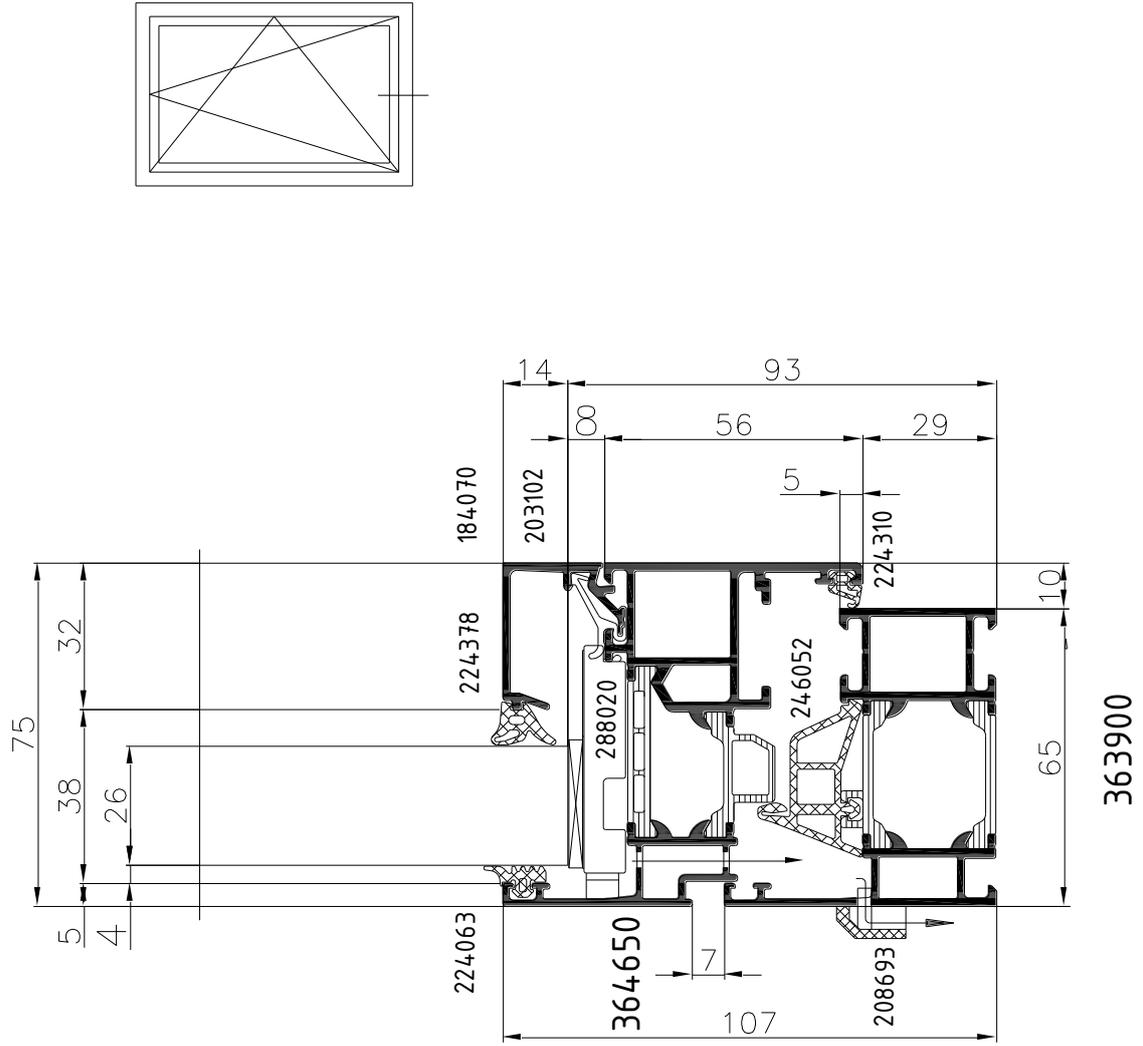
Coupe de fenêtre avec profilé T et 2 ouvrants
